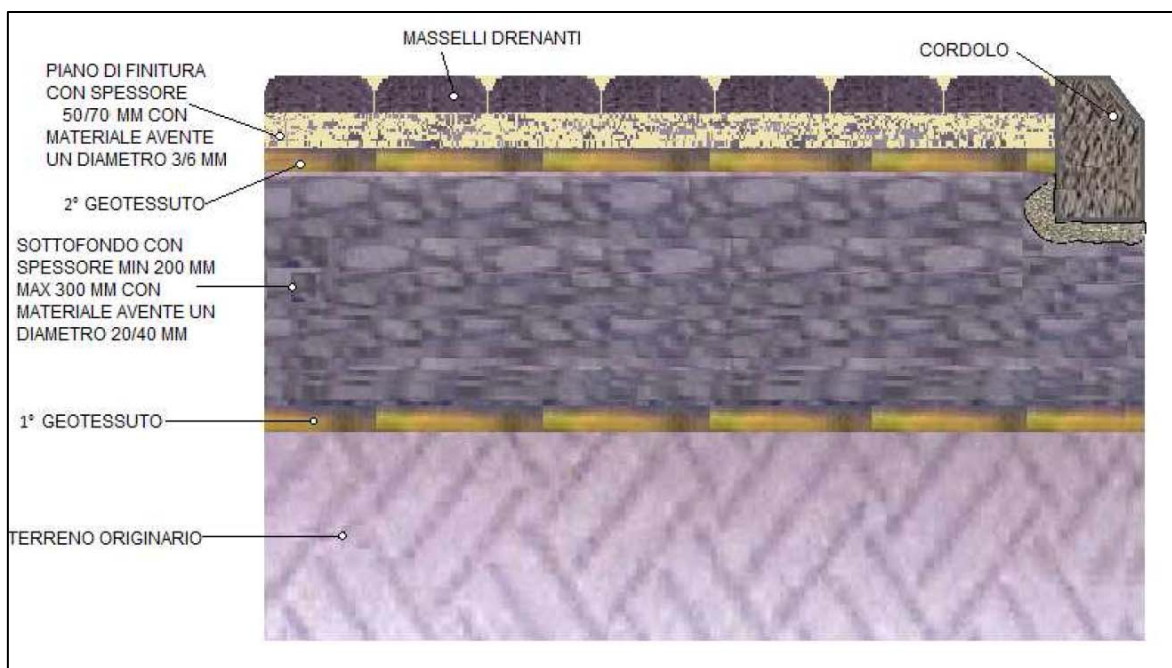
/A – Stratigrafia pavimentazione in masselli drenanti
